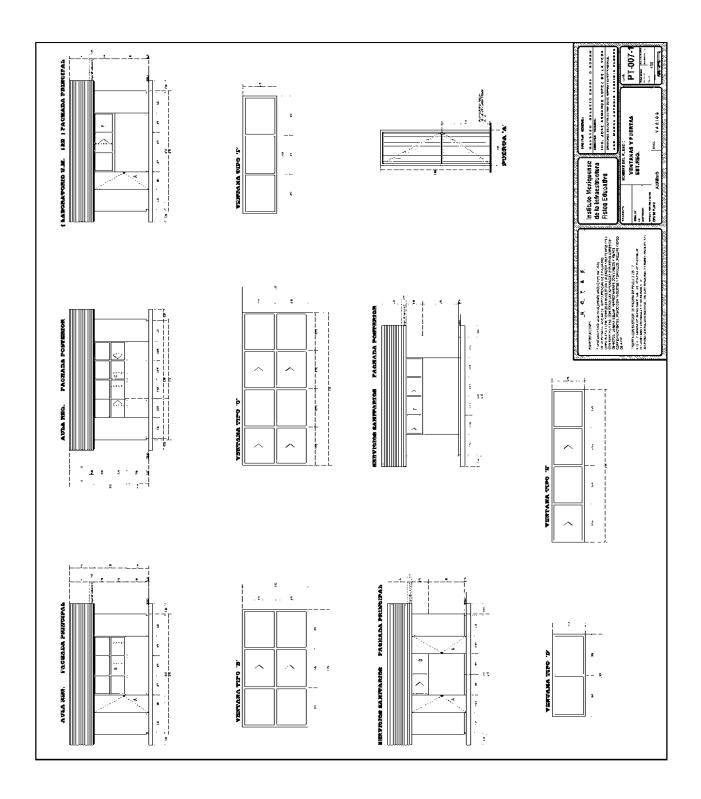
Detalle Plano de cancelería puertas y ventanas.
